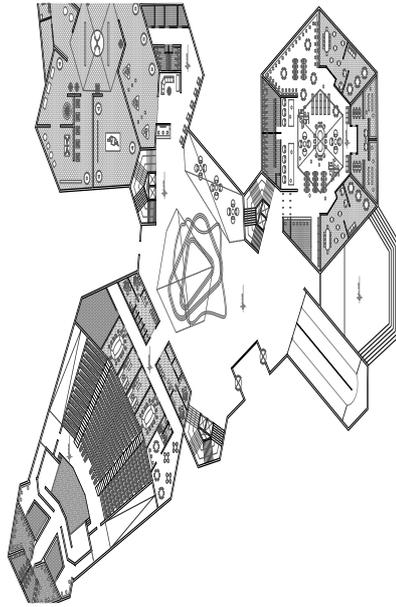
Planta Baja sin contexto. Elaboración propia
